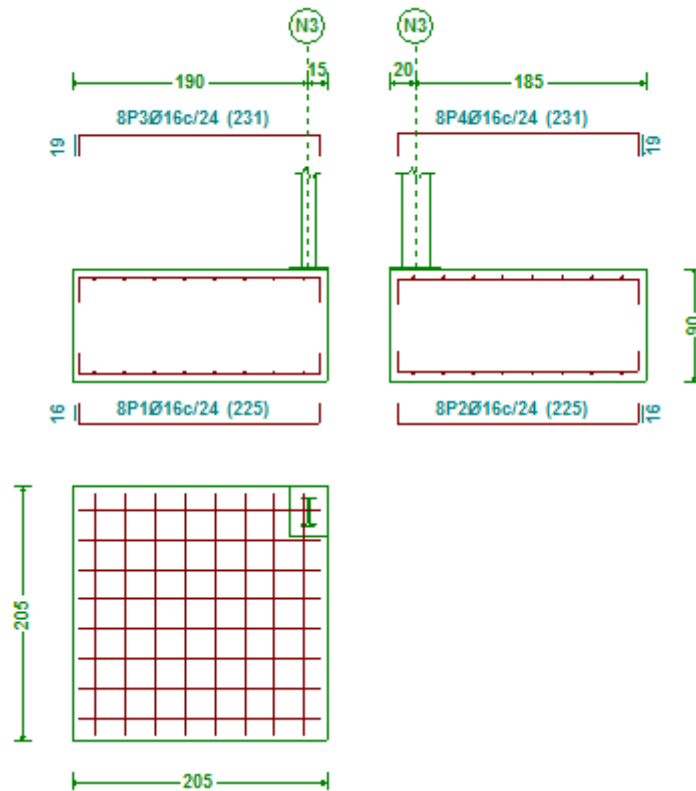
Zapata pilar exterior derecho del pórtico de fachada trasero (Tipo 5)
